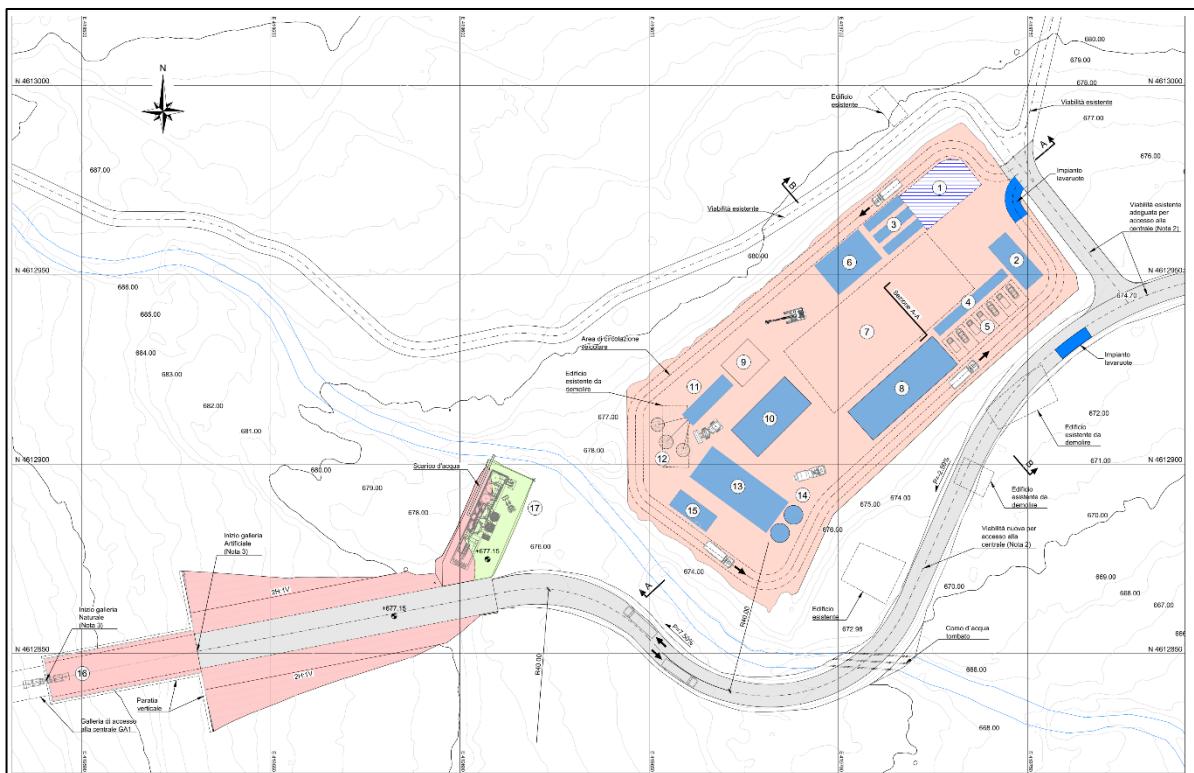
Ambito Pizzone - Area di cantiere CO.03 – Galleria di accesso alla centrale
